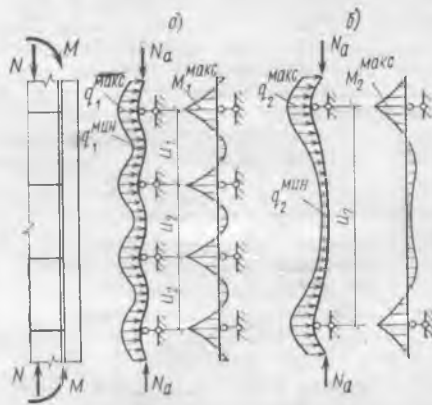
Схема нагружения сжатой арматуры поперечным давлением бетона
